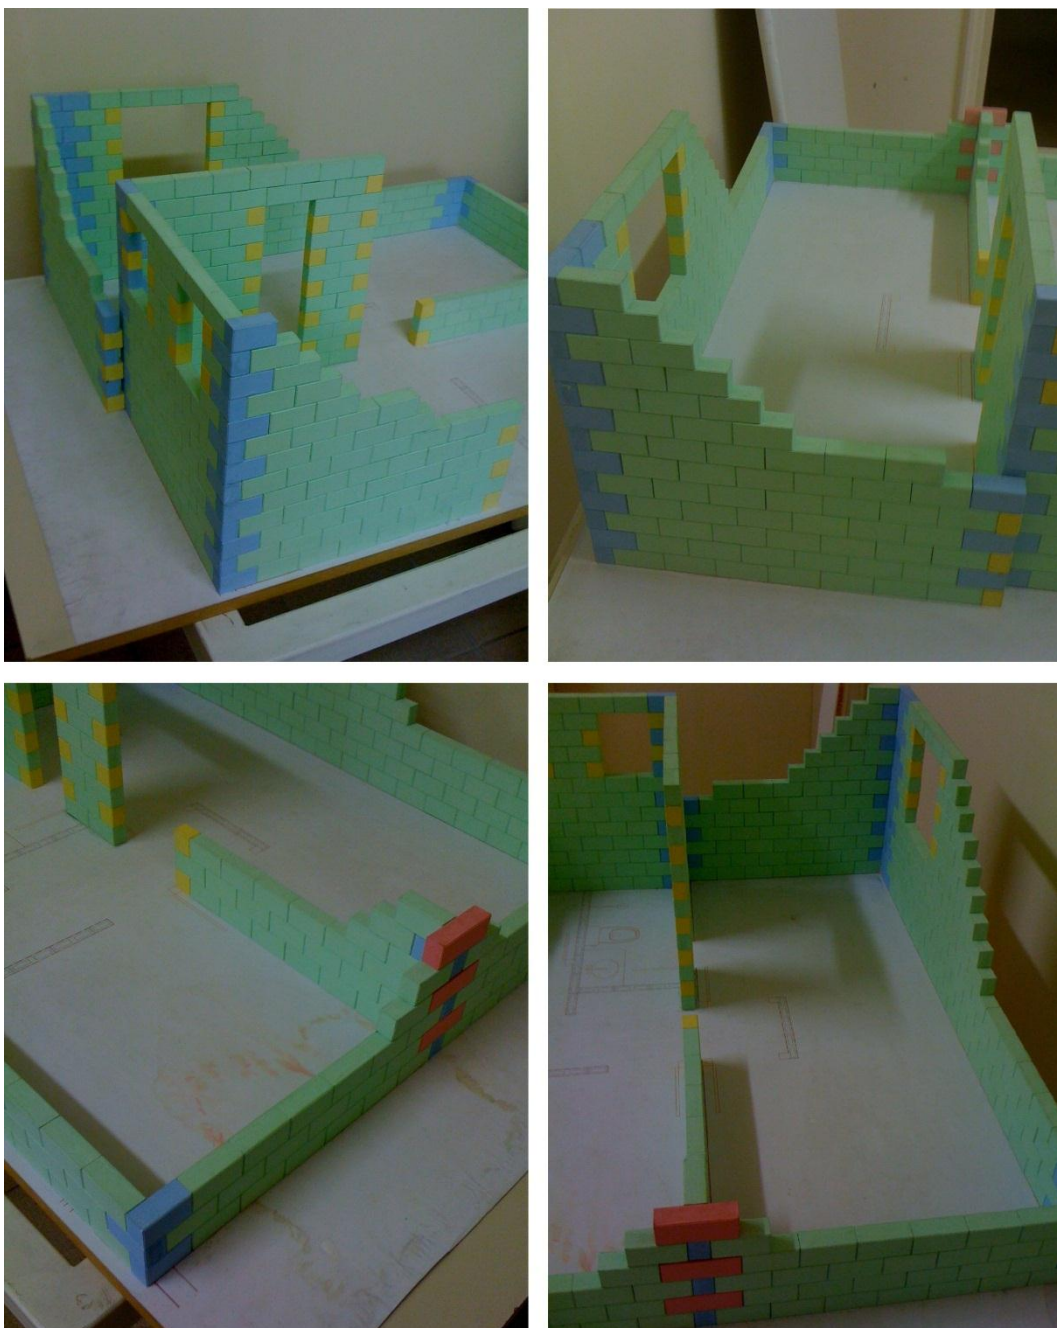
Maquete de um projeto em alvenaria estrutural.
